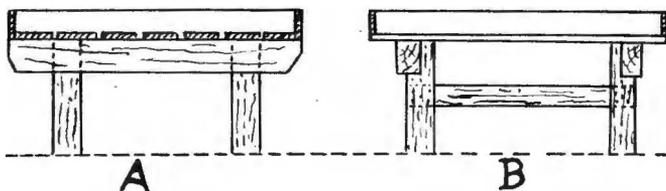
Dos tipos de banquinas de madera. A, tablas colocadas longitudinalmente. B, tablas colocadas a lo ancho.
